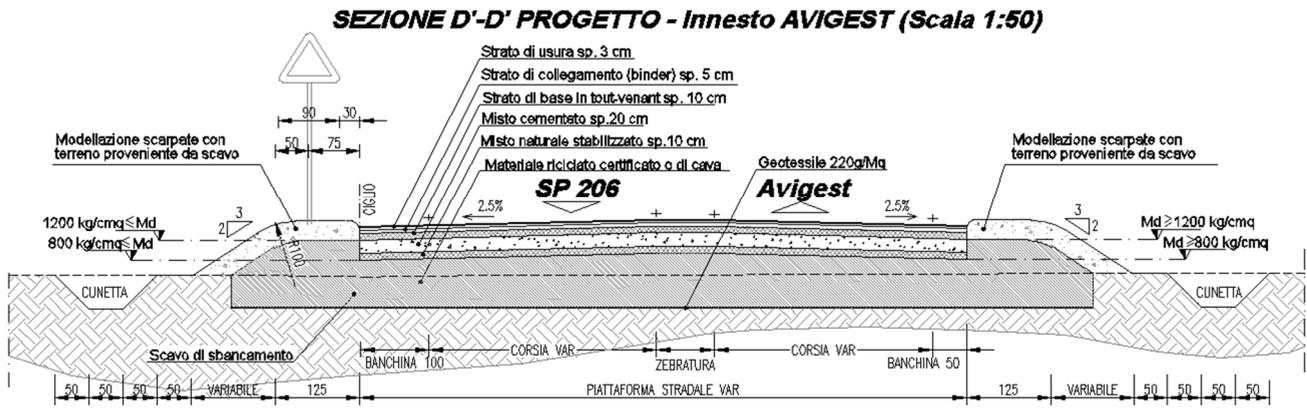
Stato di progetto Nuovo Innesto Avigest
